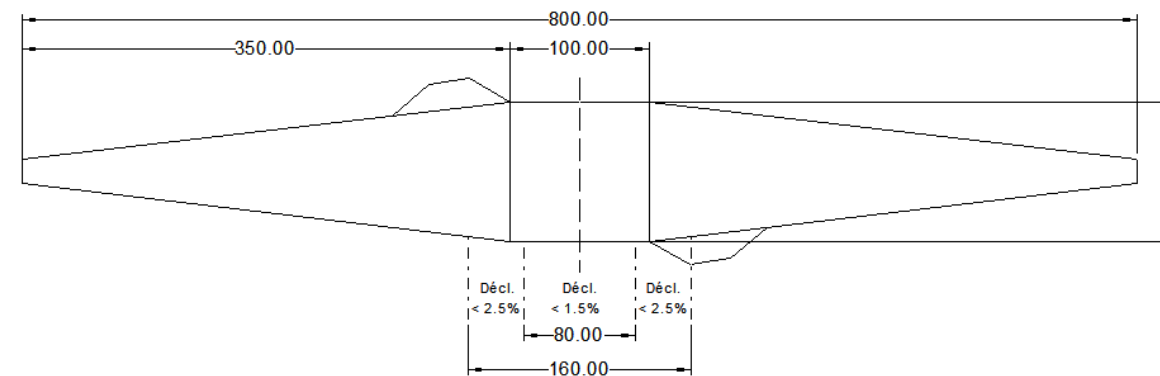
EXEMPLE DE CARACTERISTIQUES D'UNE BARRIERE DE PEEGE PLEINE VOIE, VUE EN PLAN EN METRES
